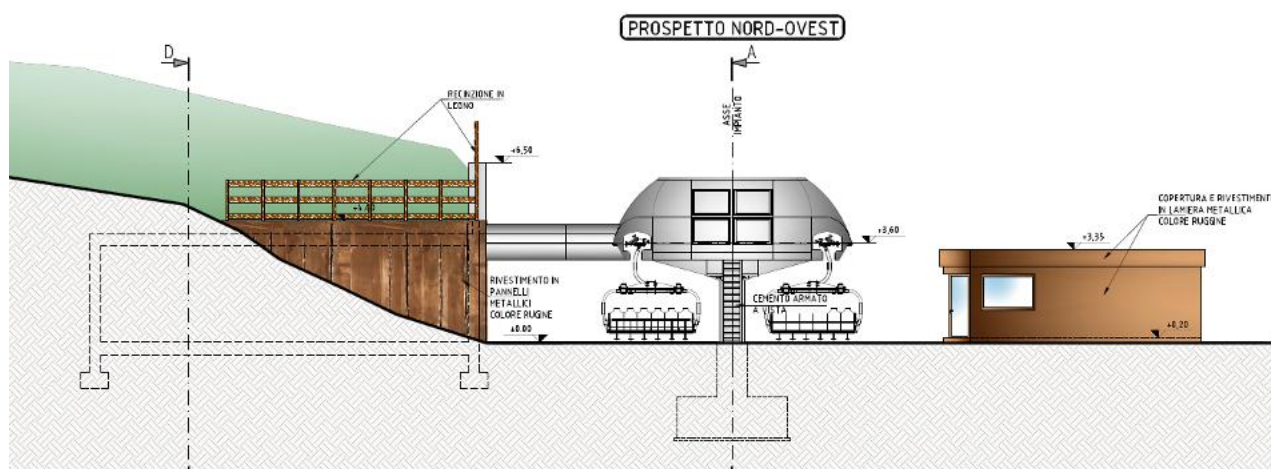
prospetto nord – ovest stazione di valle seggiovia - scala a vista
